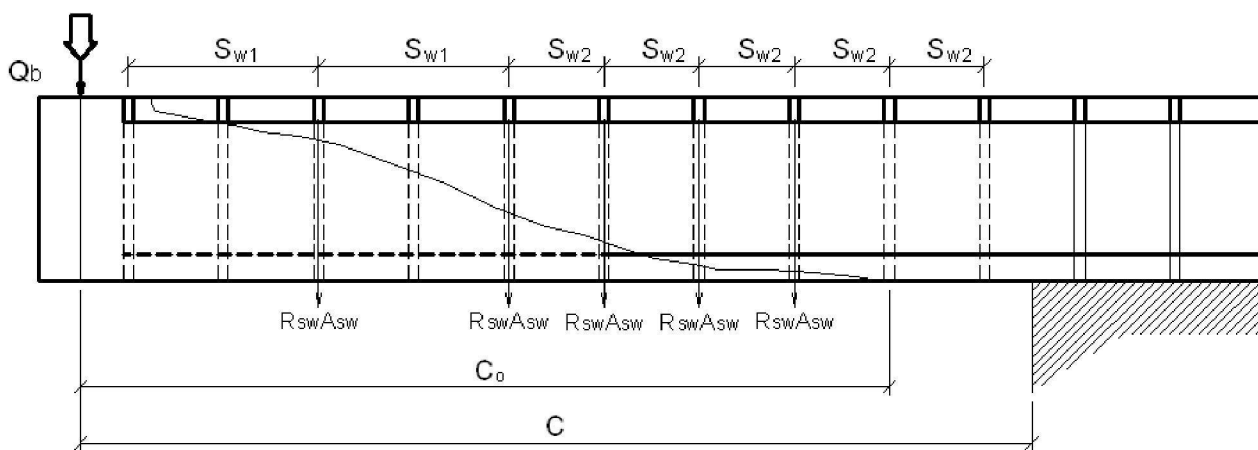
Схема усилий в наклонном сечении при расчёте его на поперечную силу
